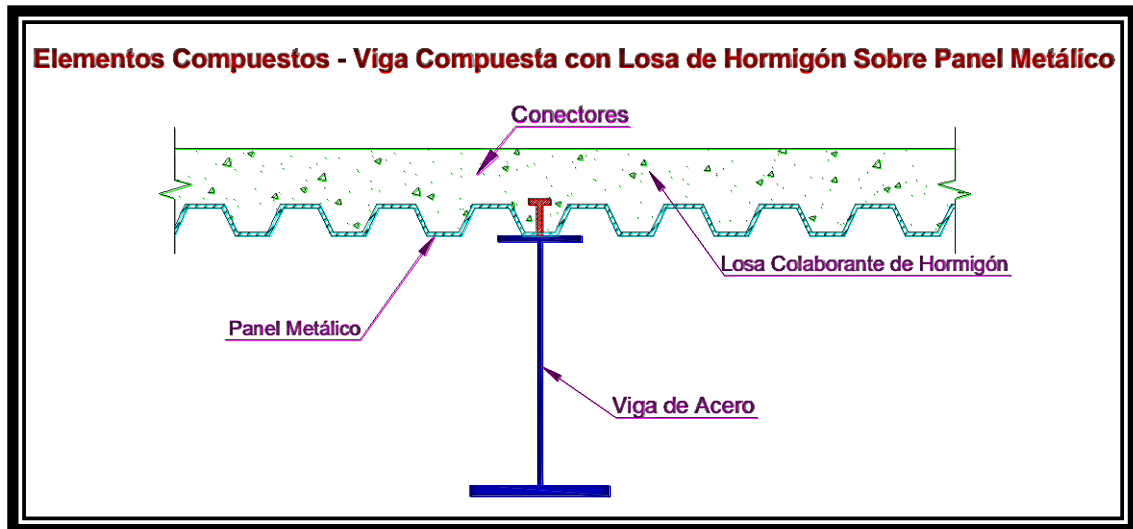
4: Viga Compuesta con Losa de Hormigón sobre Panel Metálico.
